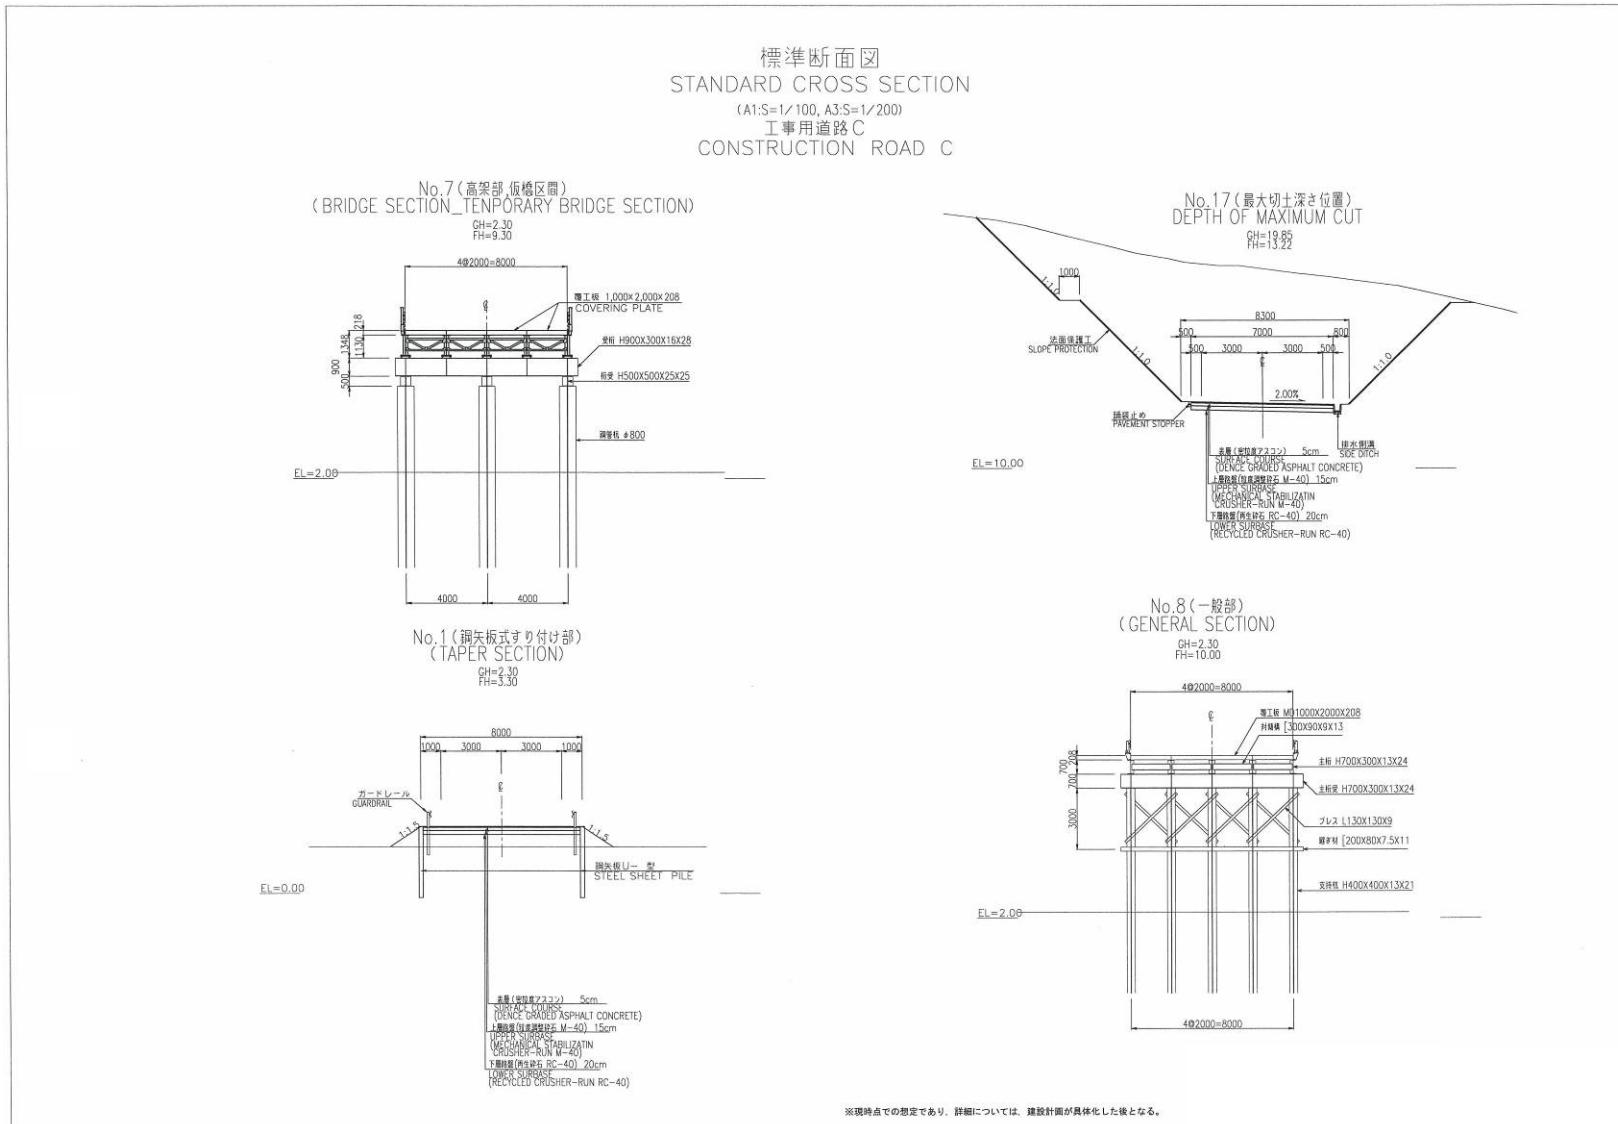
(3) 工事用仮設道路標準断面図 (C 区間)
